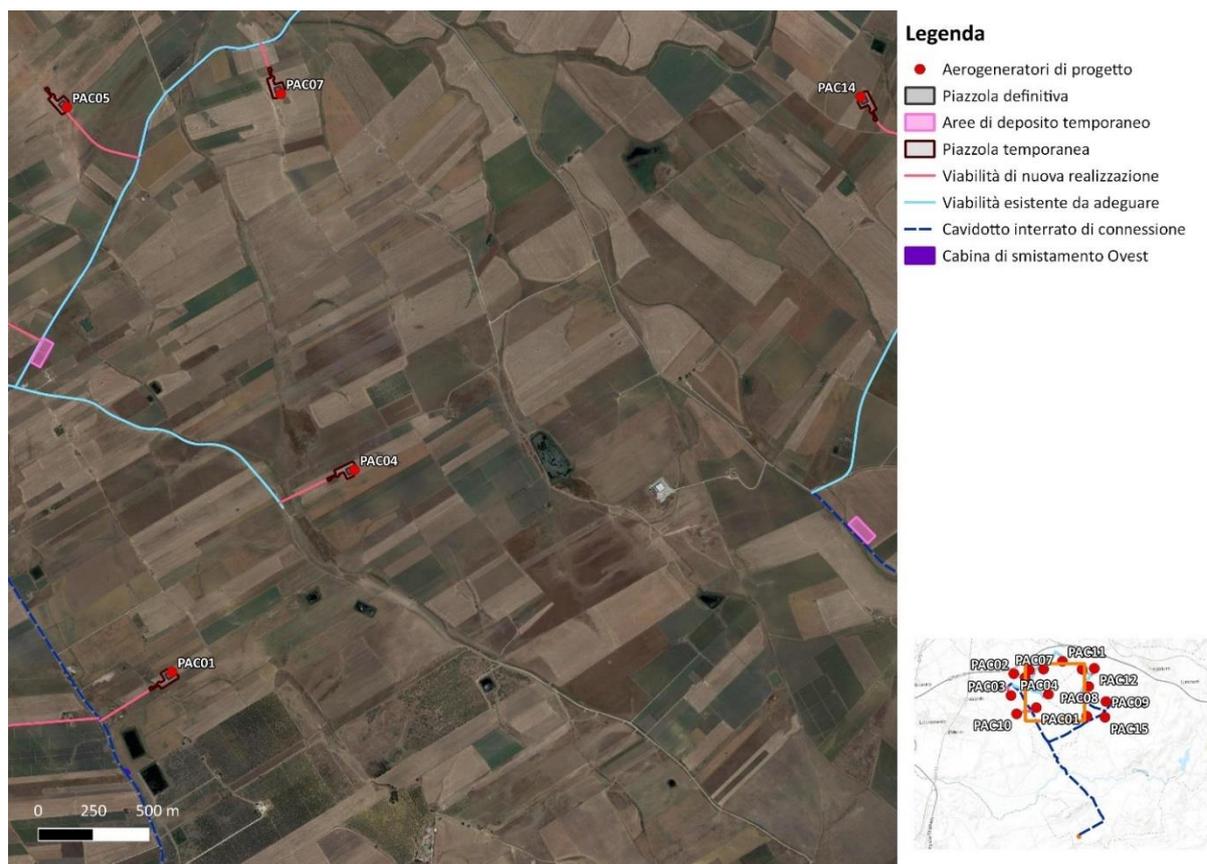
Localizzazione delle aree temporanee di cantiere previste rispetto al layout di impianto.
